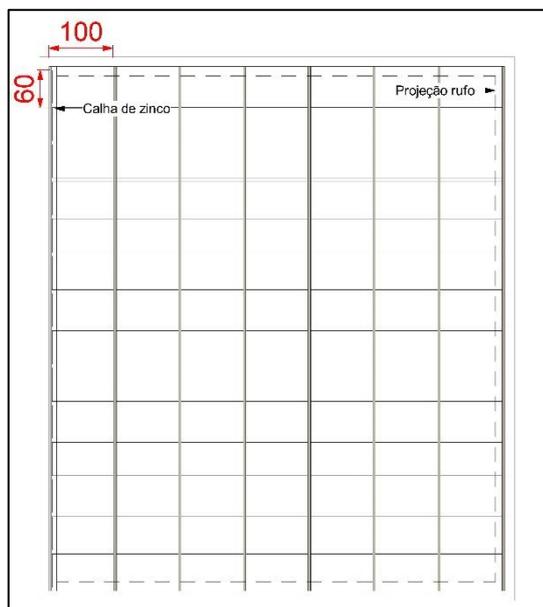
Planta de cobertura embutida com telha fibrocimento
